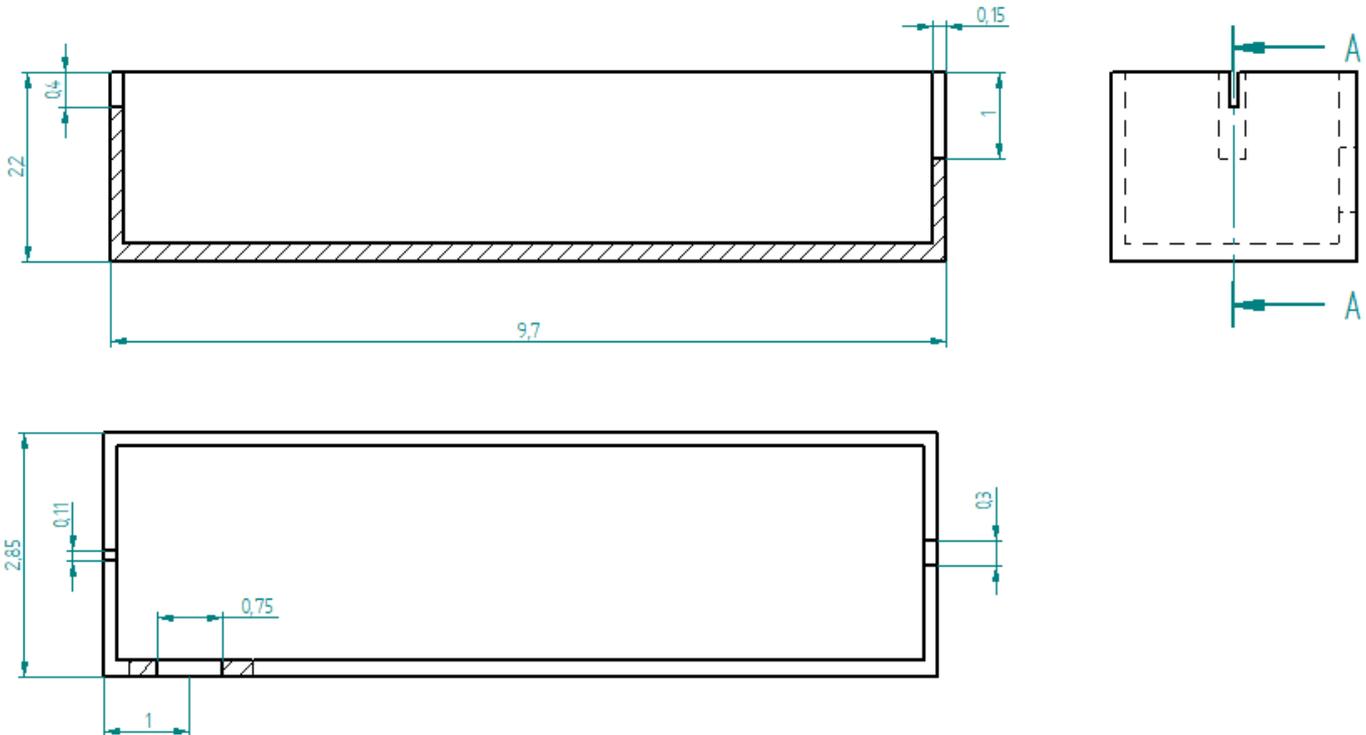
Plano constructivo de la obra de llegada (cotas en metros).
